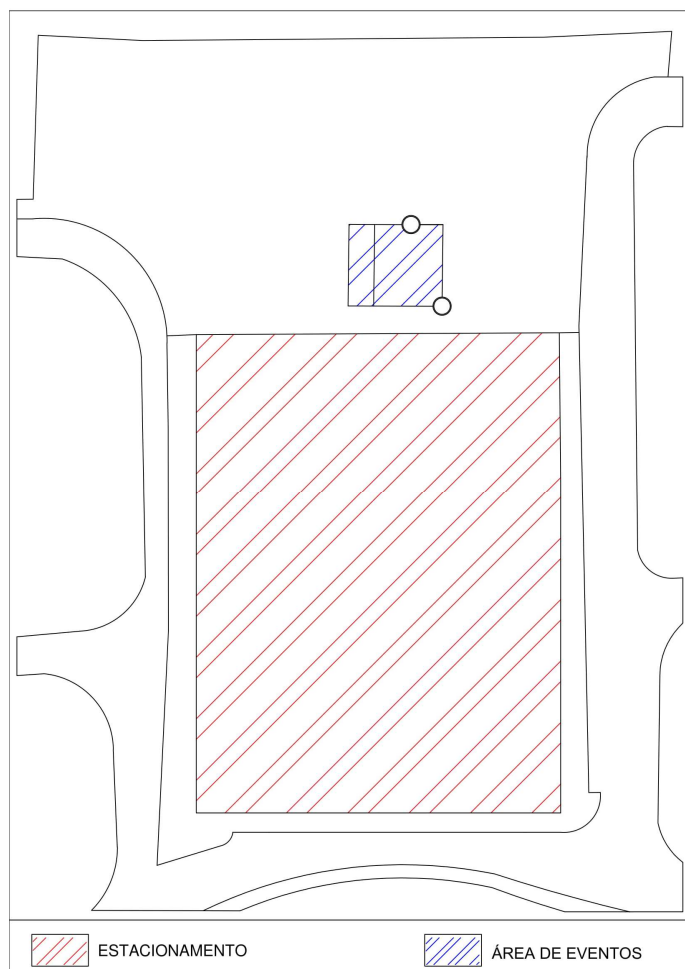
Planta de delimitação para o pavimento térreo proposto
